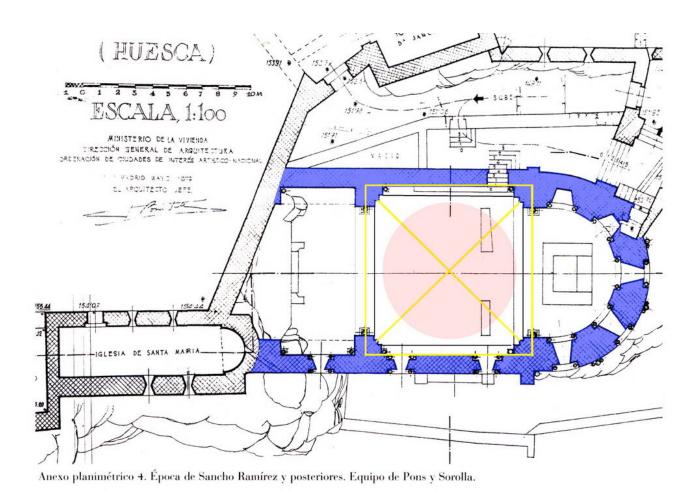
San Pedro de Loarre. Planta de Pons Sorolla.
